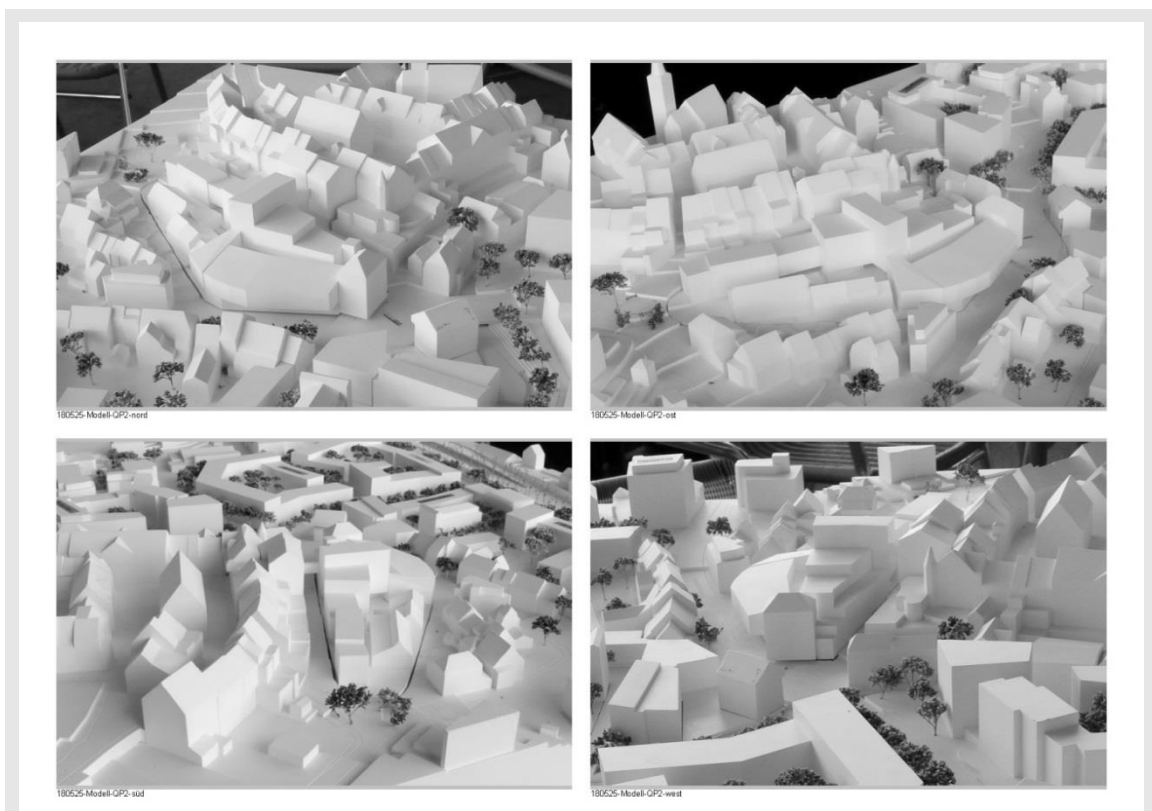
Quartier mit Ergänzungsbauten gemäss neuem Quartierplan Ziegelhof II, Modell 1:500, Foto: Baubüro in situ AG
